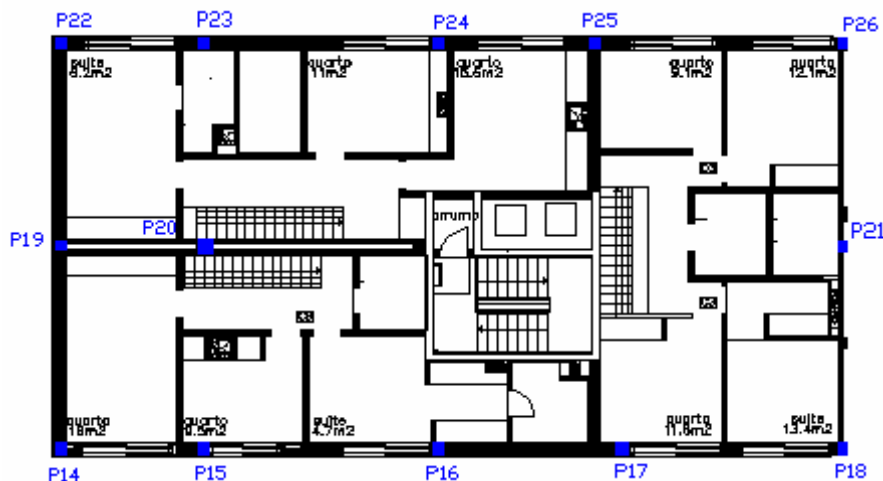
Planta de arquitectura modificada do 7º Piso
